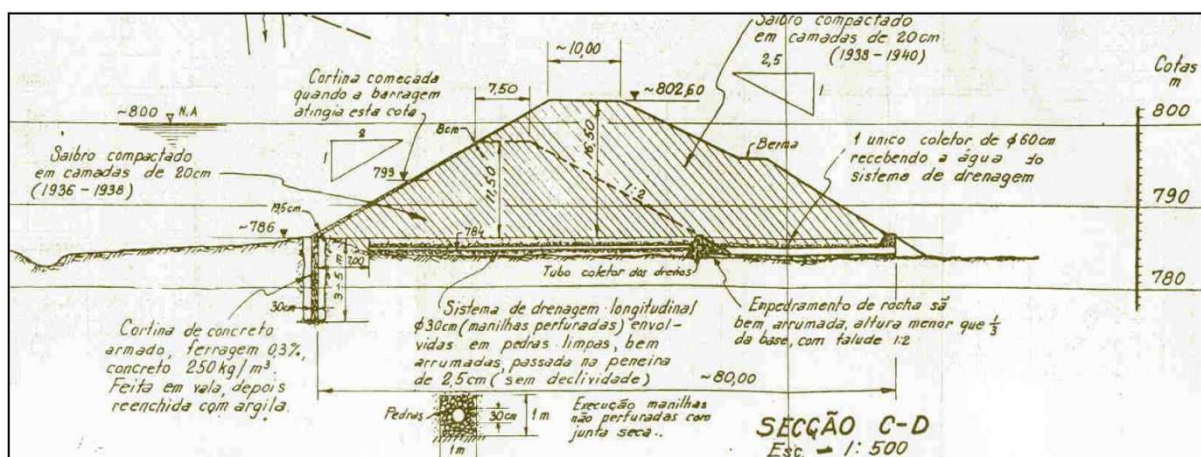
Barragem da Pampulha com parede de concreto impermeável na fundação
